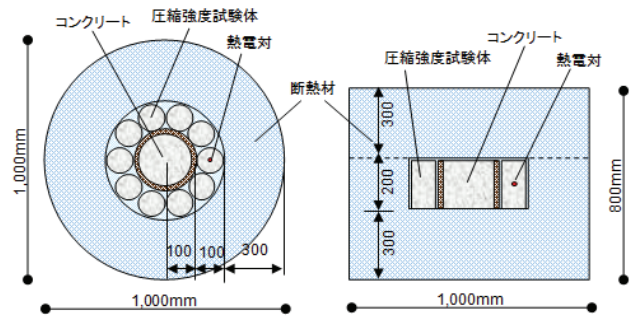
簡易断熱養生供試体の詳細 (Details of Heat Insulation Specimen)
